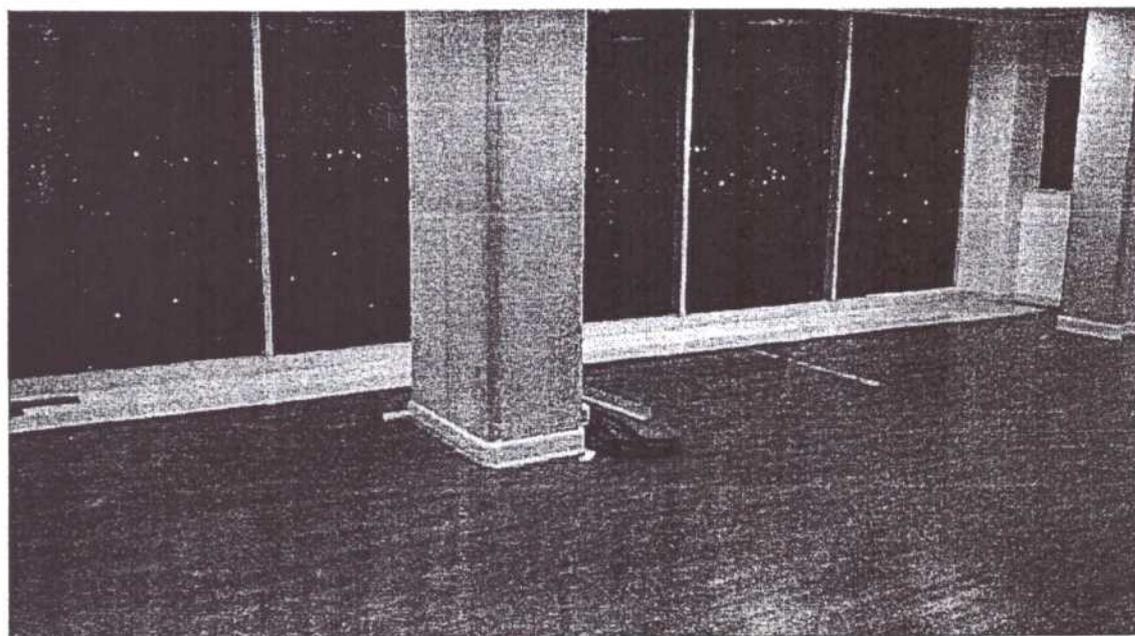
Ventanería de la fachada Norte – Oficina 1304
